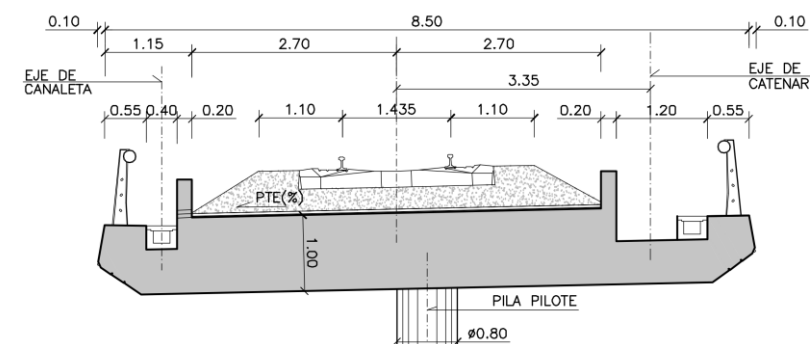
SECCIÓN TIPO PI TERCER CANAL DE RIEGO DE LEVANTE Y CAMINO P.K. 3+600
